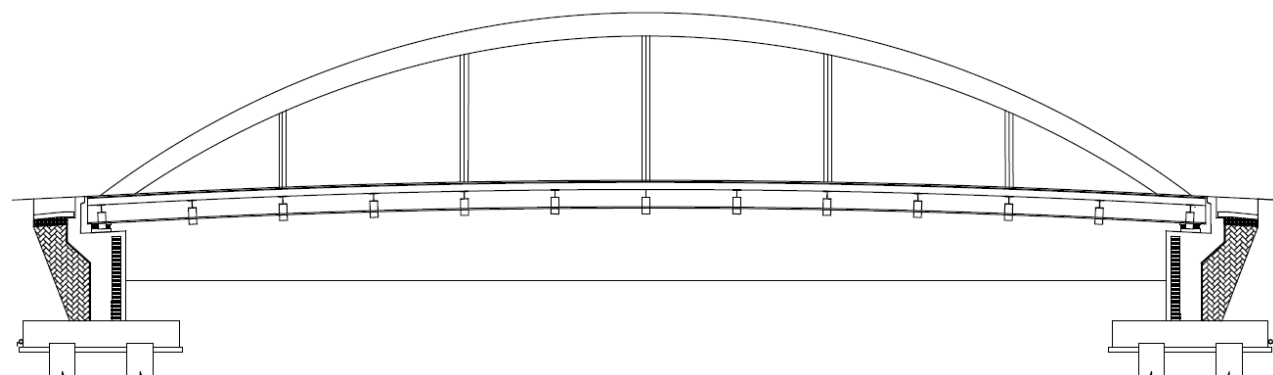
Propuesta A - Alzado lateral del puente. Elaboración propia con AutoCAD.
